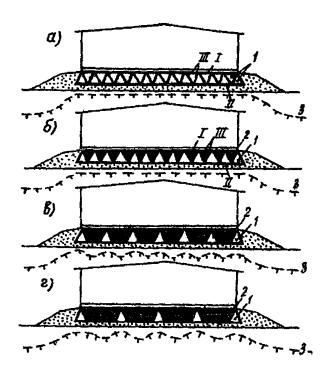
Рис. I. Схемы охландения грунтов оснований плитных фундаментов:
